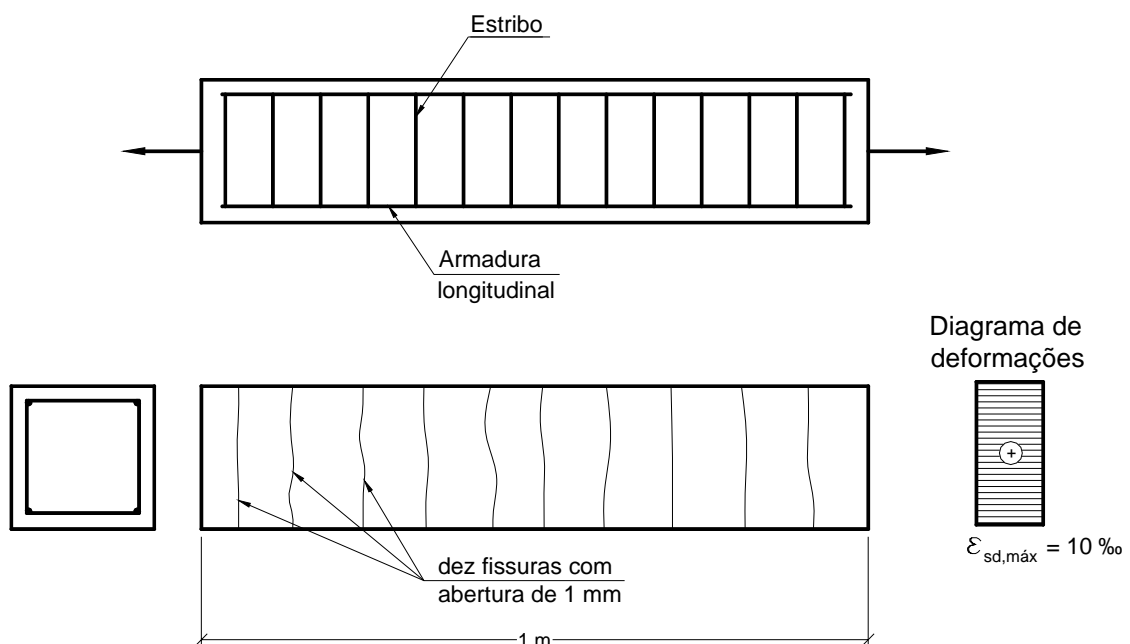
Fissuras num tirante com deformação de alongamento de 10 ‰.
